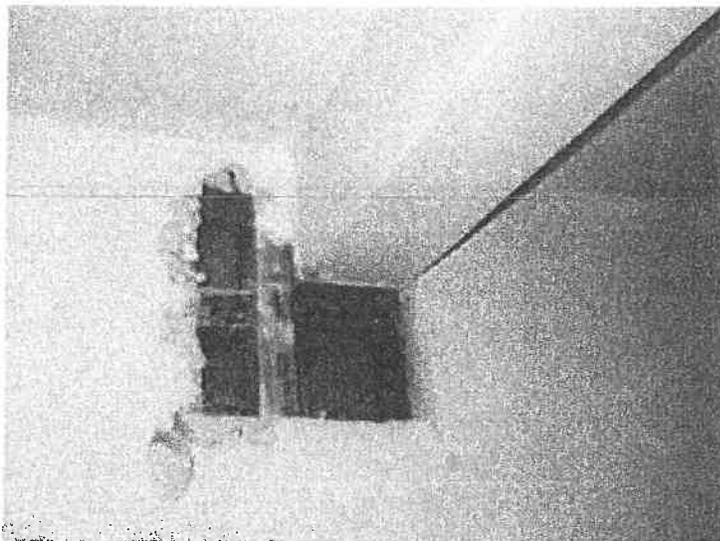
Structure au plafond du mur mitoyen (porteur) au 2^e étage de la salle communautaire
